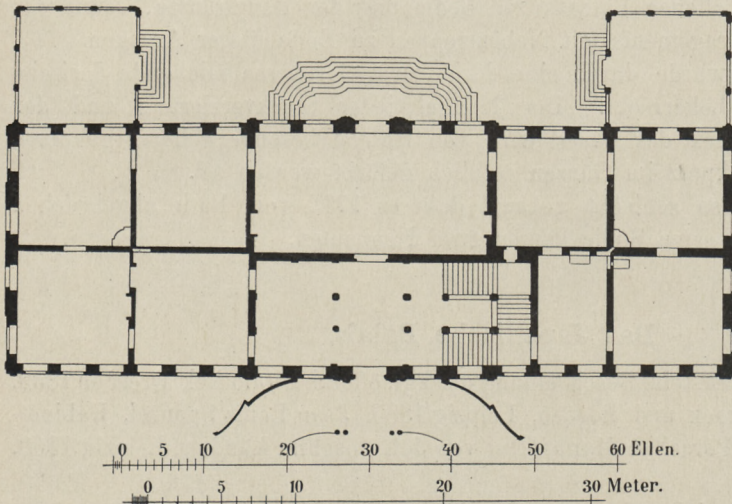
Holländisches Palais. Grundriss des Erdgeschosses.
